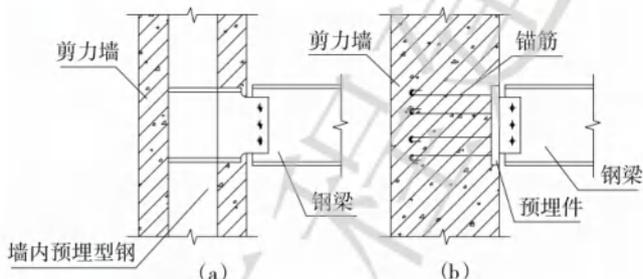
钢梁与混凝土剪力墙的铰接连接示意
